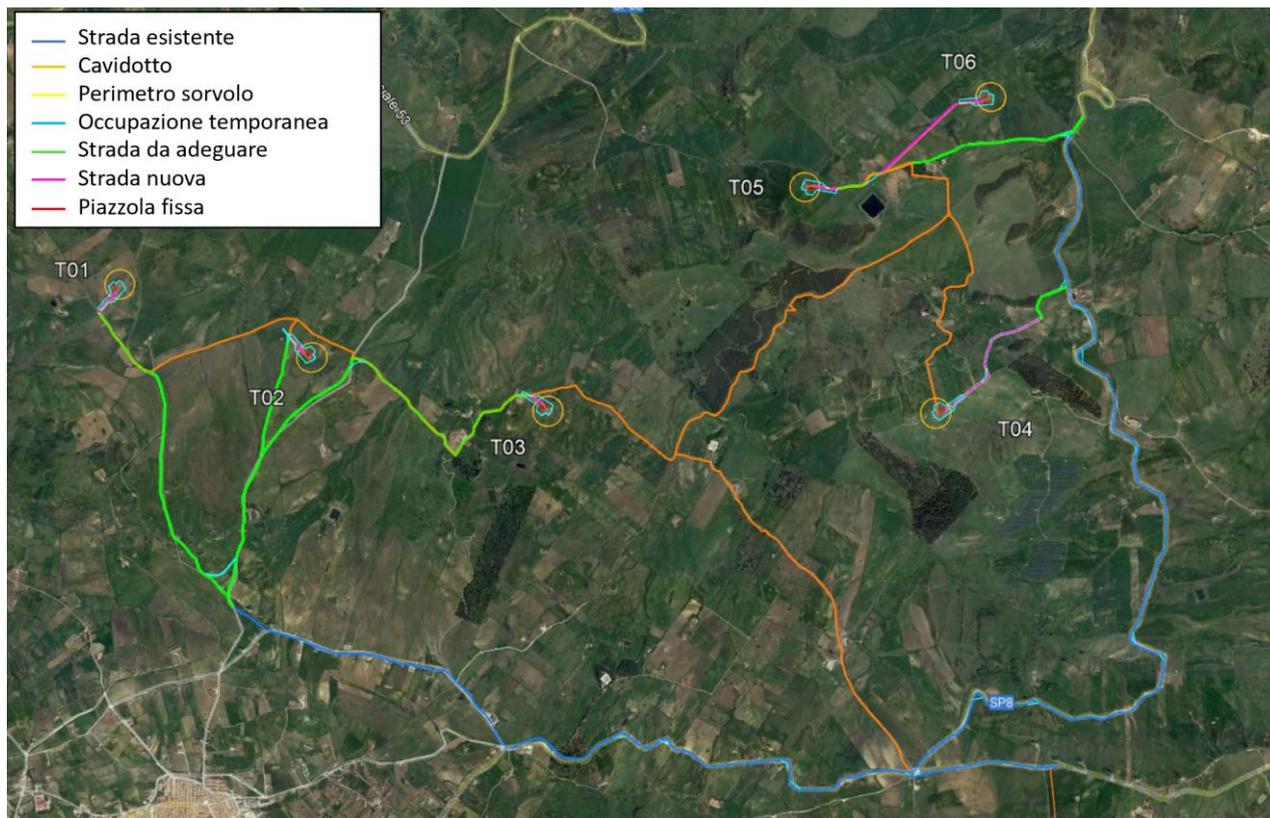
Stralcio su ortofoto con indicazione delle piazzole di progetto
